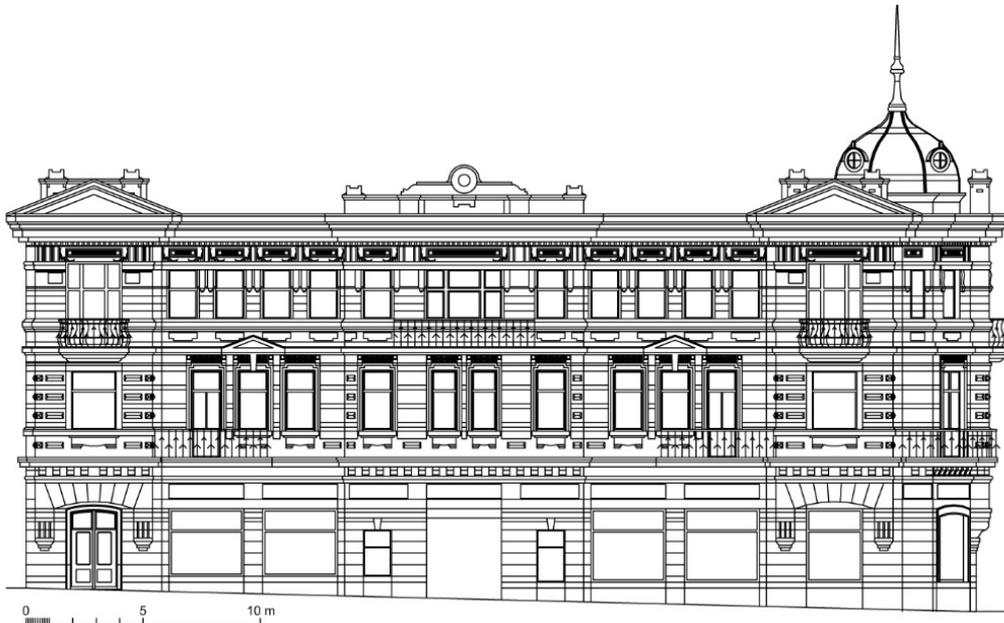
Доходный дом Бабинцевых. Фасад со стороны ул. Алеутской
